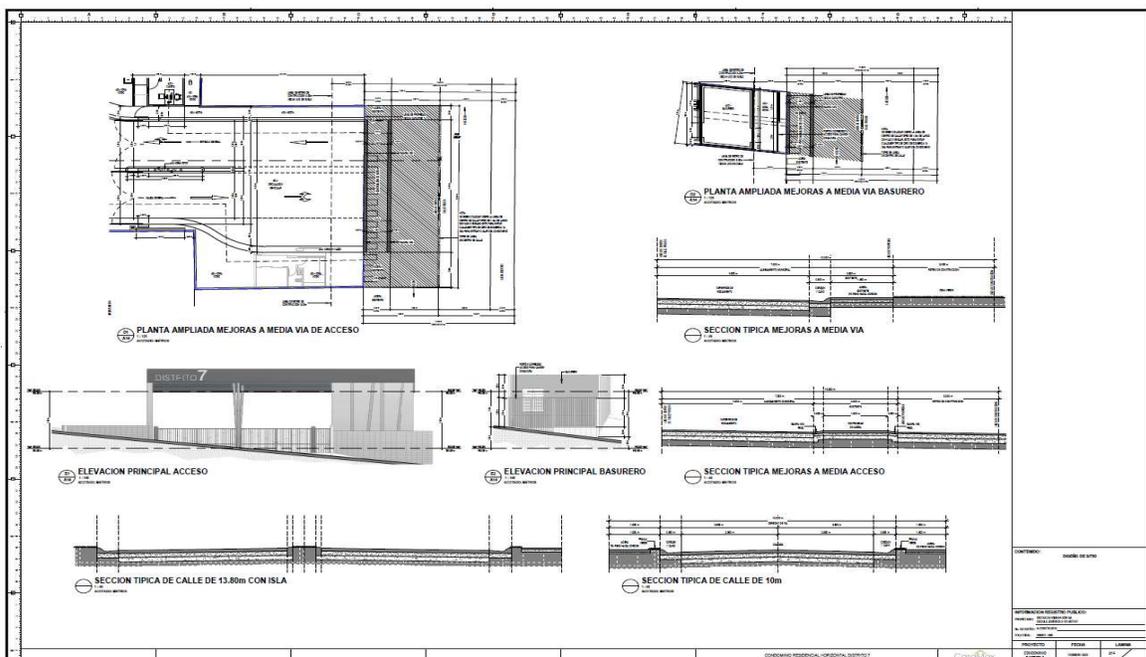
Mejoras a la mitad del derecho de vía. Lamina constructiva # A14.
